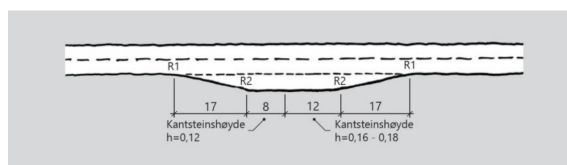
Skal-krav utforming av plattform (hentet fra håndbok N100 (figur 4.3.3-1))
